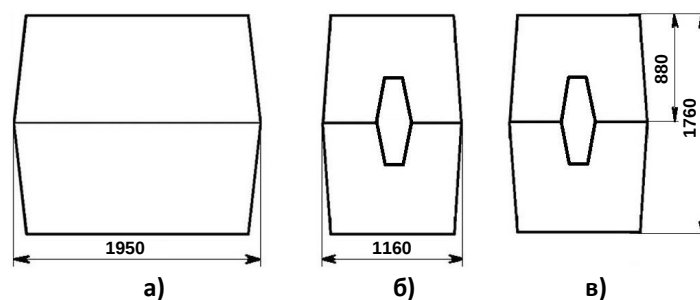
Габаритные размеры колодца «ККСр-3-10»:
